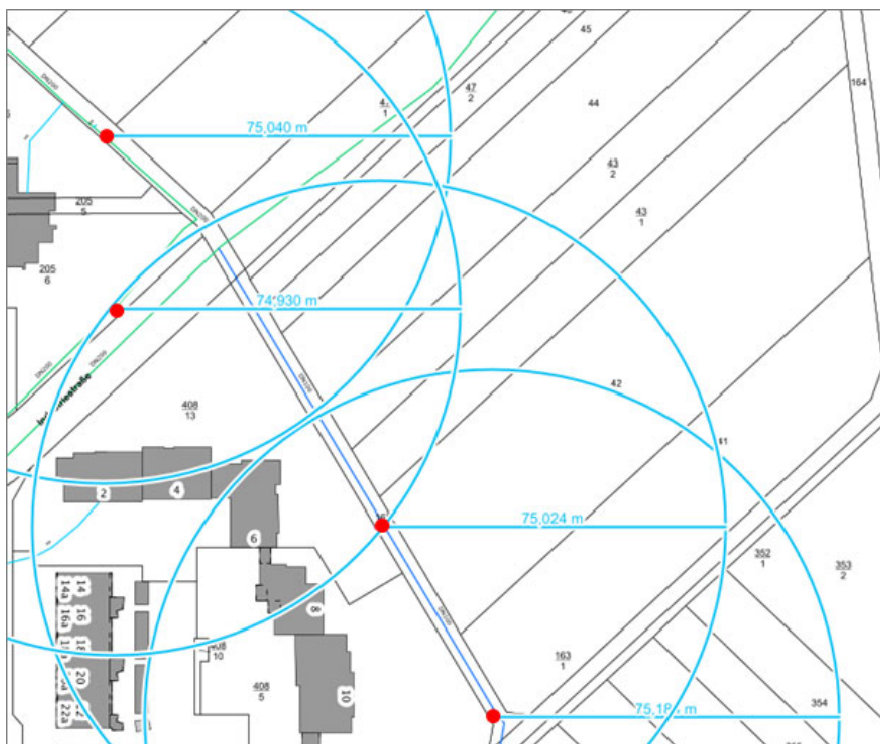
Lageplan mit eingezeichneten Hydrantenstandorten (Radius 75m)
